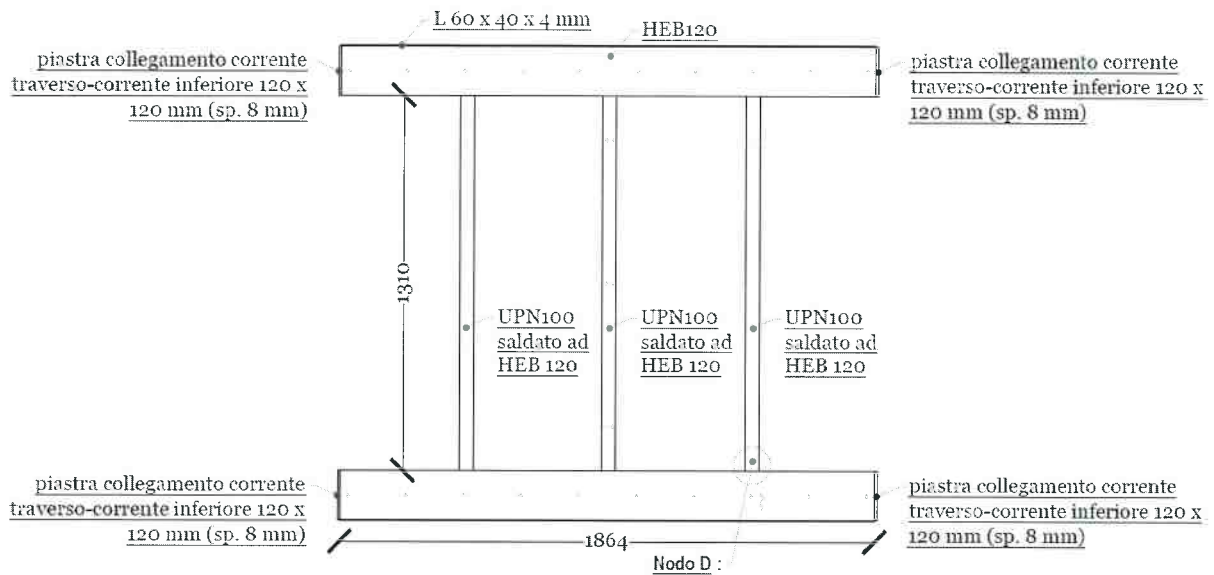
Pianta dell'elemento costruttivo: pianale tipo 1
